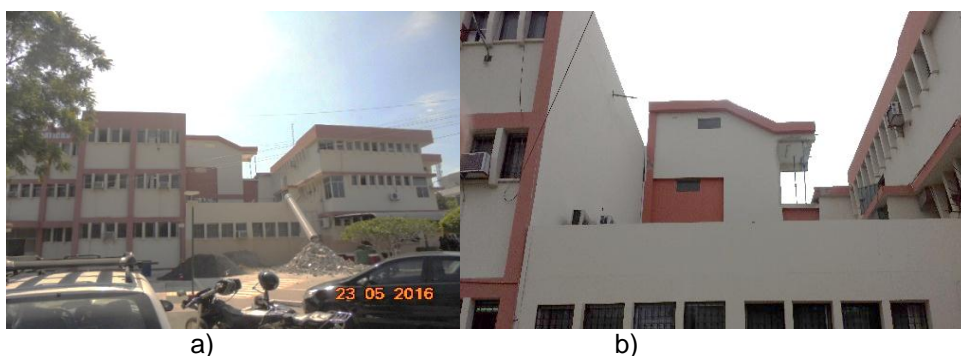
a) Vista Frontal Facultad de Informática b) Fachada bloque de Gradass.
